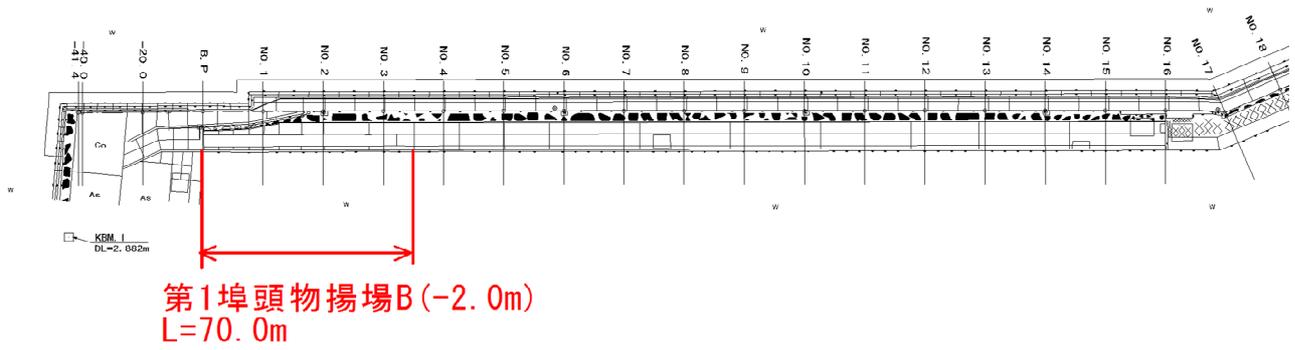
No.25 大洗港区_第1埠頭地区B物揚場 (-2m) の平面図 (被災前)
